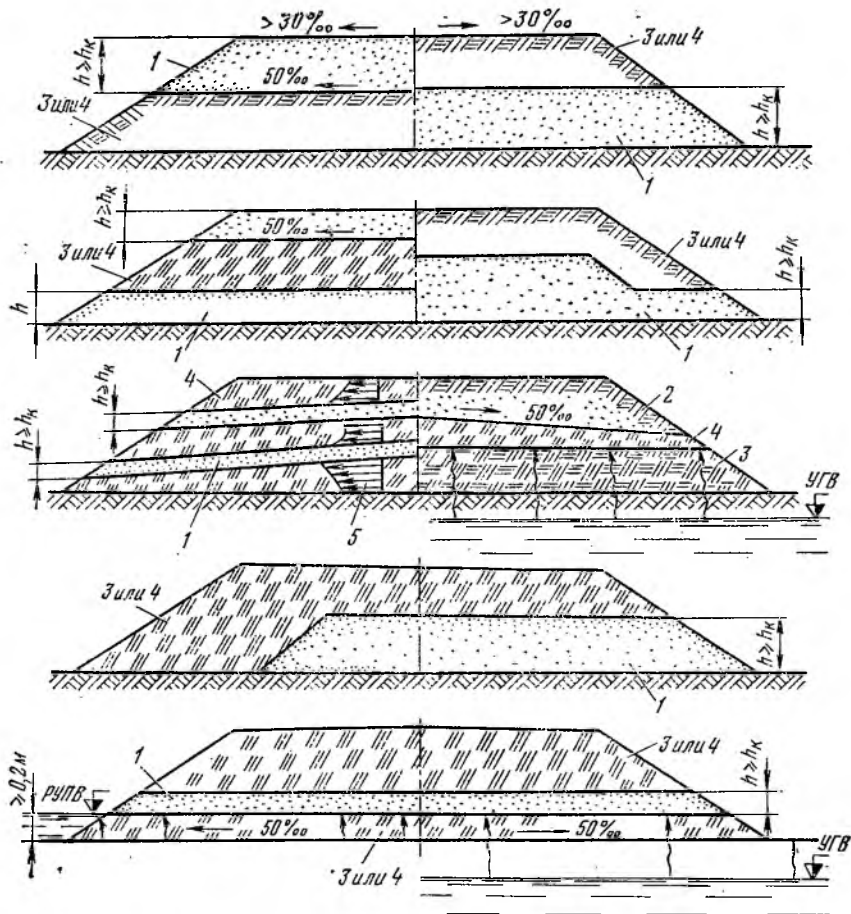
Схема допустимого расположения грунтов в насыпи:
